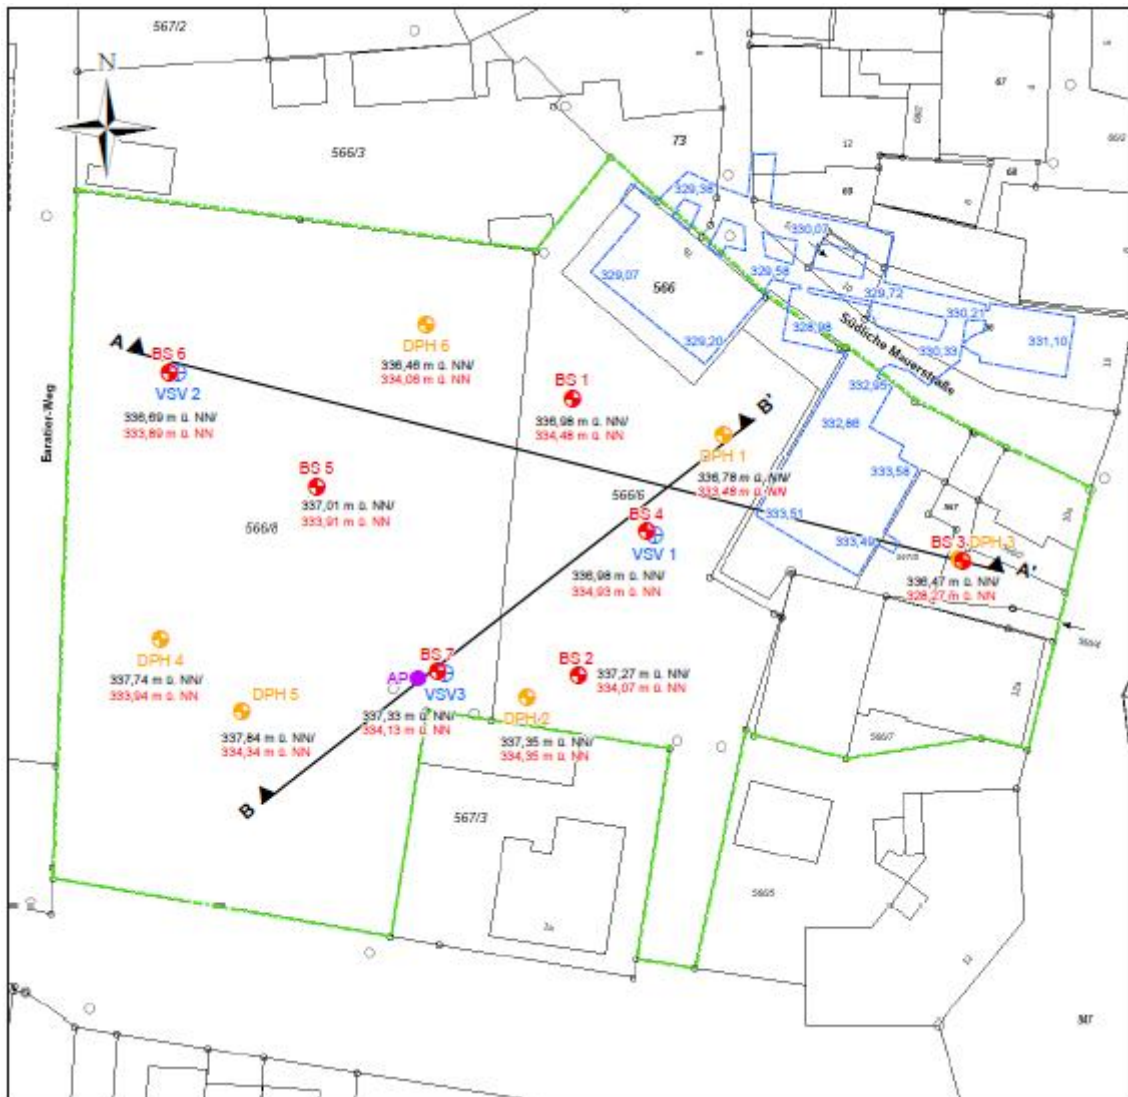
Unmaßstäblicher Lageplan mit den Ansatzpunkten, dem geplanten Baufeld sowie den zwei Profilschnitlinien A-A' und B-B'.
